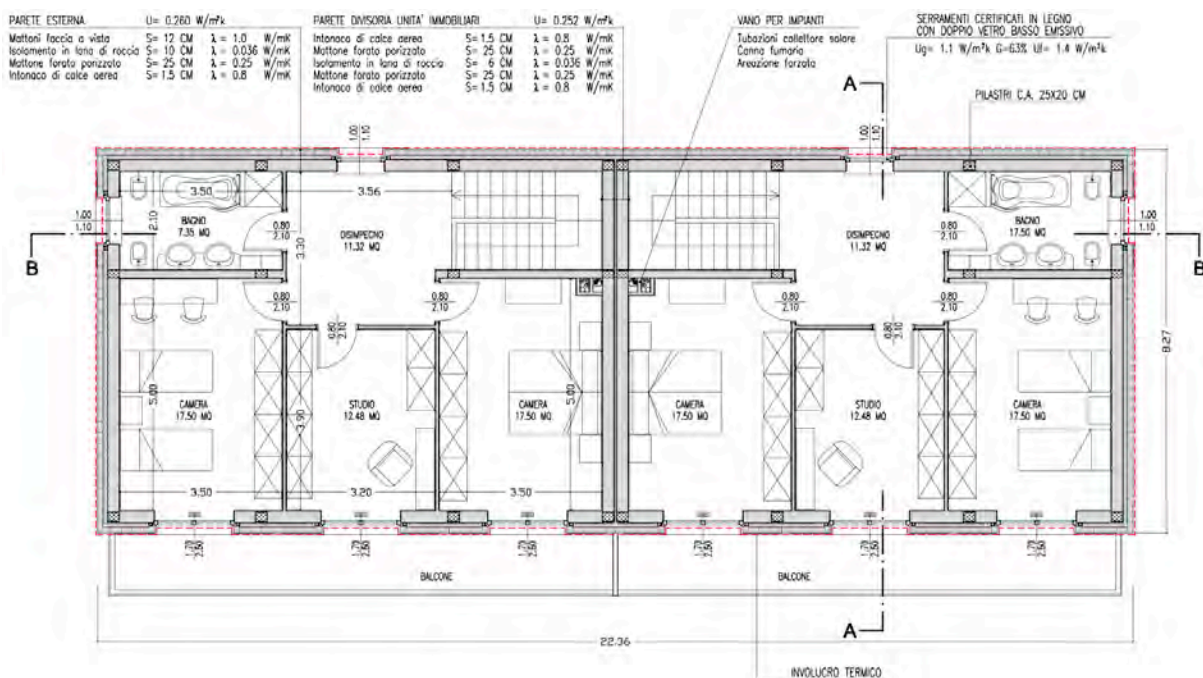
Bifamiliare 4: Pianta P.1 - archivio personale
